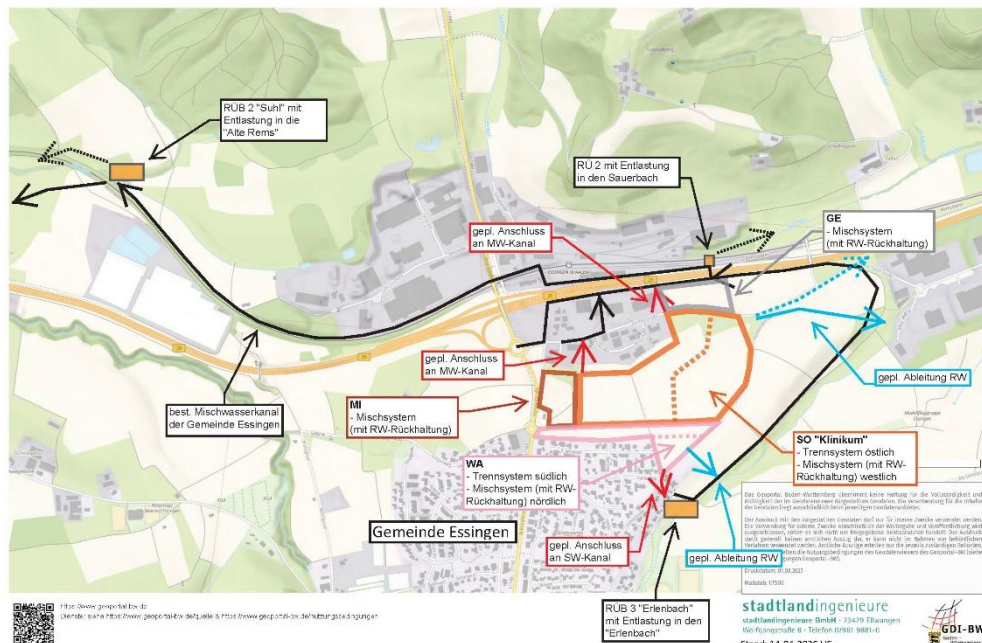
Grobkonzept Entwässerung (eigene Darstellung, Stand 14.04.2026)
